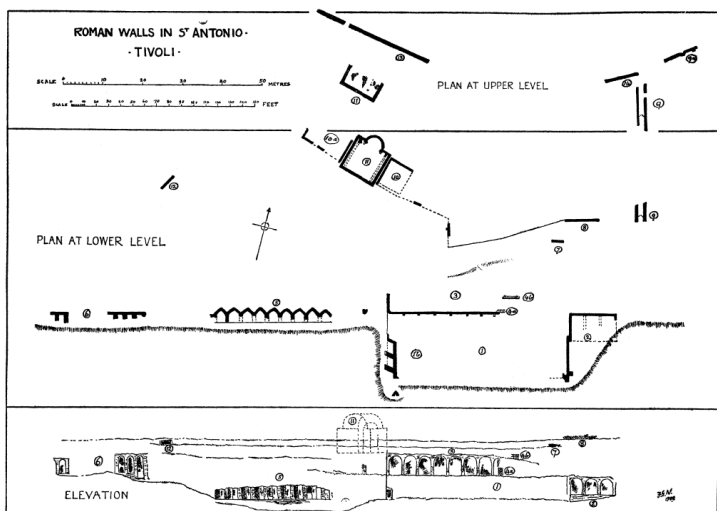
Planta de los restos de la villa de Horacio.²¹²
